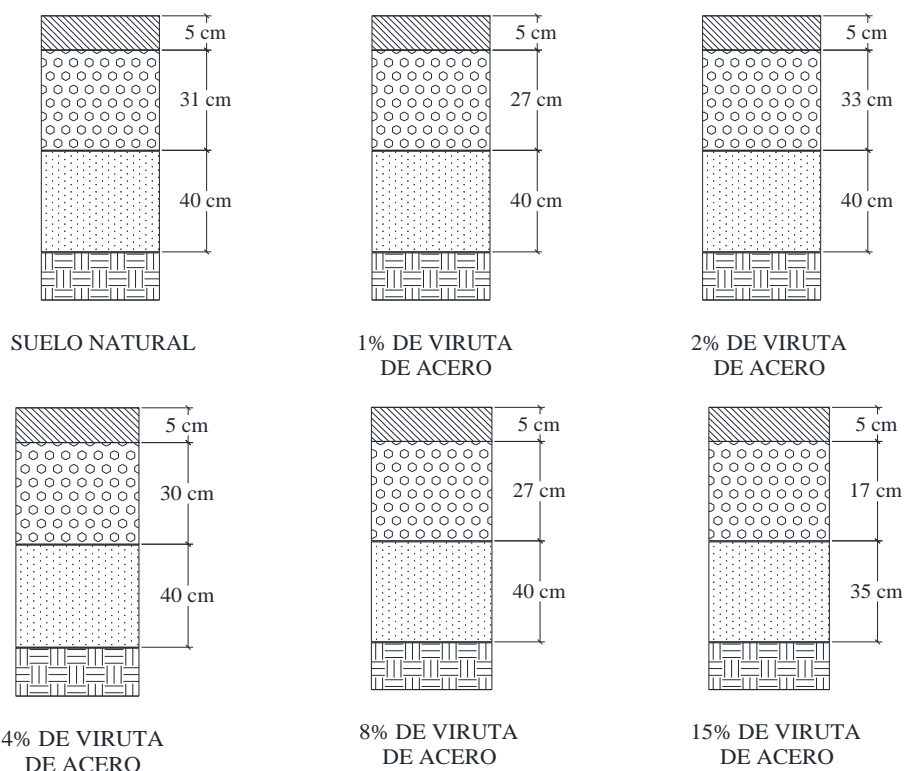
Diseño de pavimentos para las distintas subrasantes mejoradas con virutas de acero.
